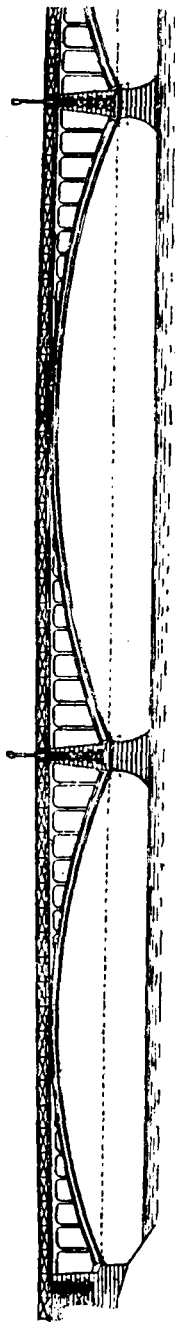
Фасадъ желѣзо-бетоннаго моста системы Геннебика въ Шателеро.
